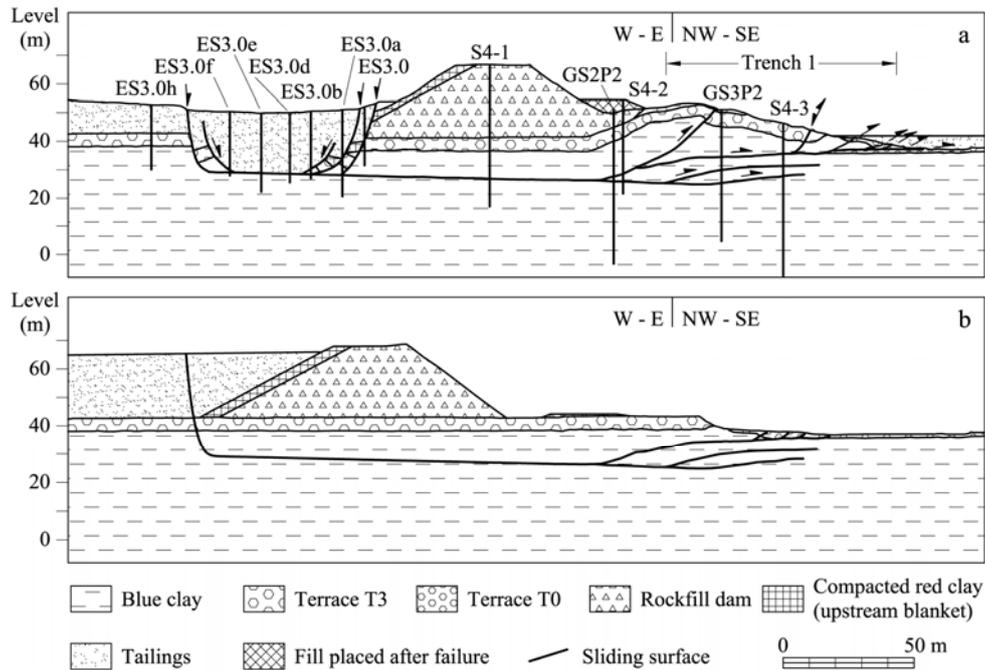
Mecanismo de rotura de la presa de Aznalcóllar. La presa deslizó sobre una superficie de rotura situada principalmente en las arcillas azules del Guadalquivir
